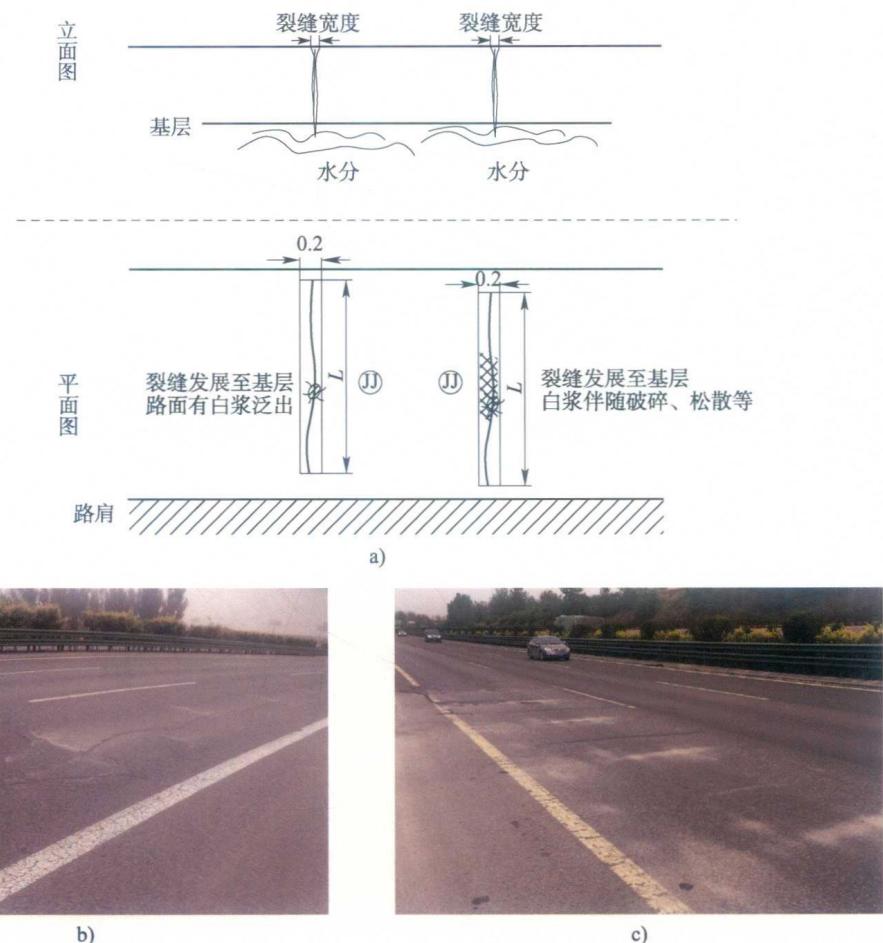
沥青混凝土路面唧浆现象 (尺寸单位: m)
